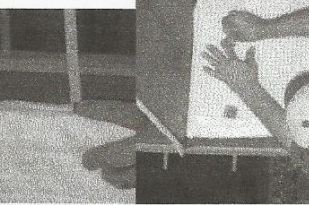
Corte el aislante, ponga la malla metálica, y ponga en su lugar
